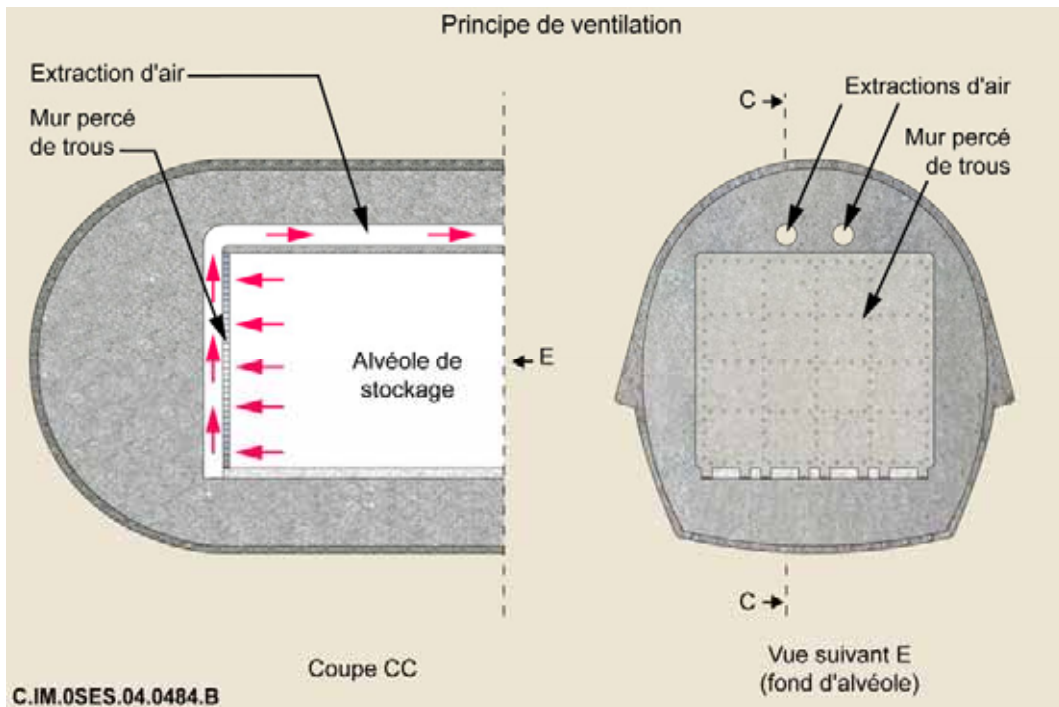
Coupe longitudinale et section du fond d'alvéole
